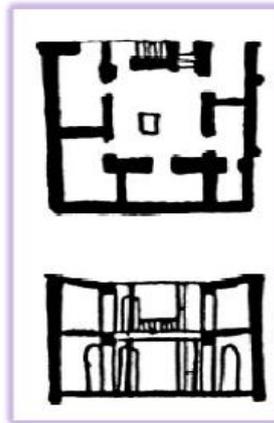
plan et coupe d'une maison sumérienne (à gauche),
